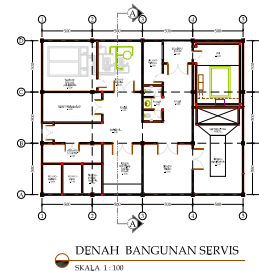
Denah Lantai 1 dan 2 Masa Penunjang
